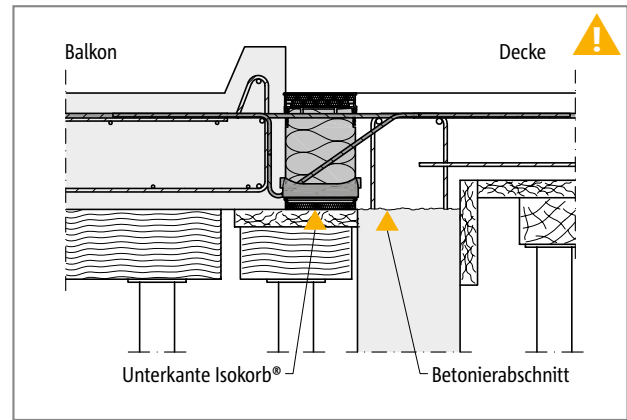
Schöck Isokorb® XT Typ K: Vollfertig-Balkon mit höhenversetzter Decke auf vorgefertigter Stahlbeton-Wand
